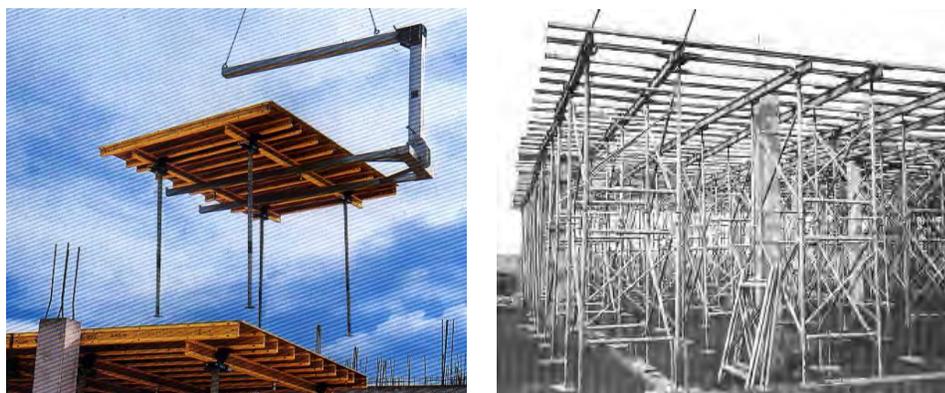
Sistema tramado para lajes: a) transporte de mesa voadora (Doka, s.d.); b) vigamento superior e inferior em aço, apoiados em torres metálicas – Fonte FREIRE (2001).
